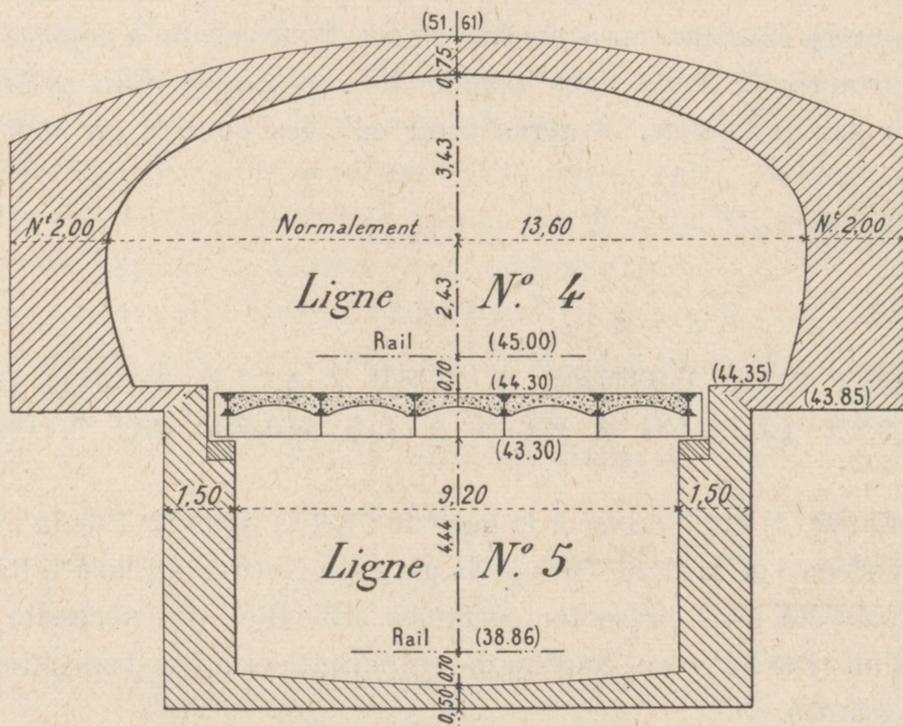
COUPE SUIVANT E. F. DU PLAN FIG. 2, PL. VII.
